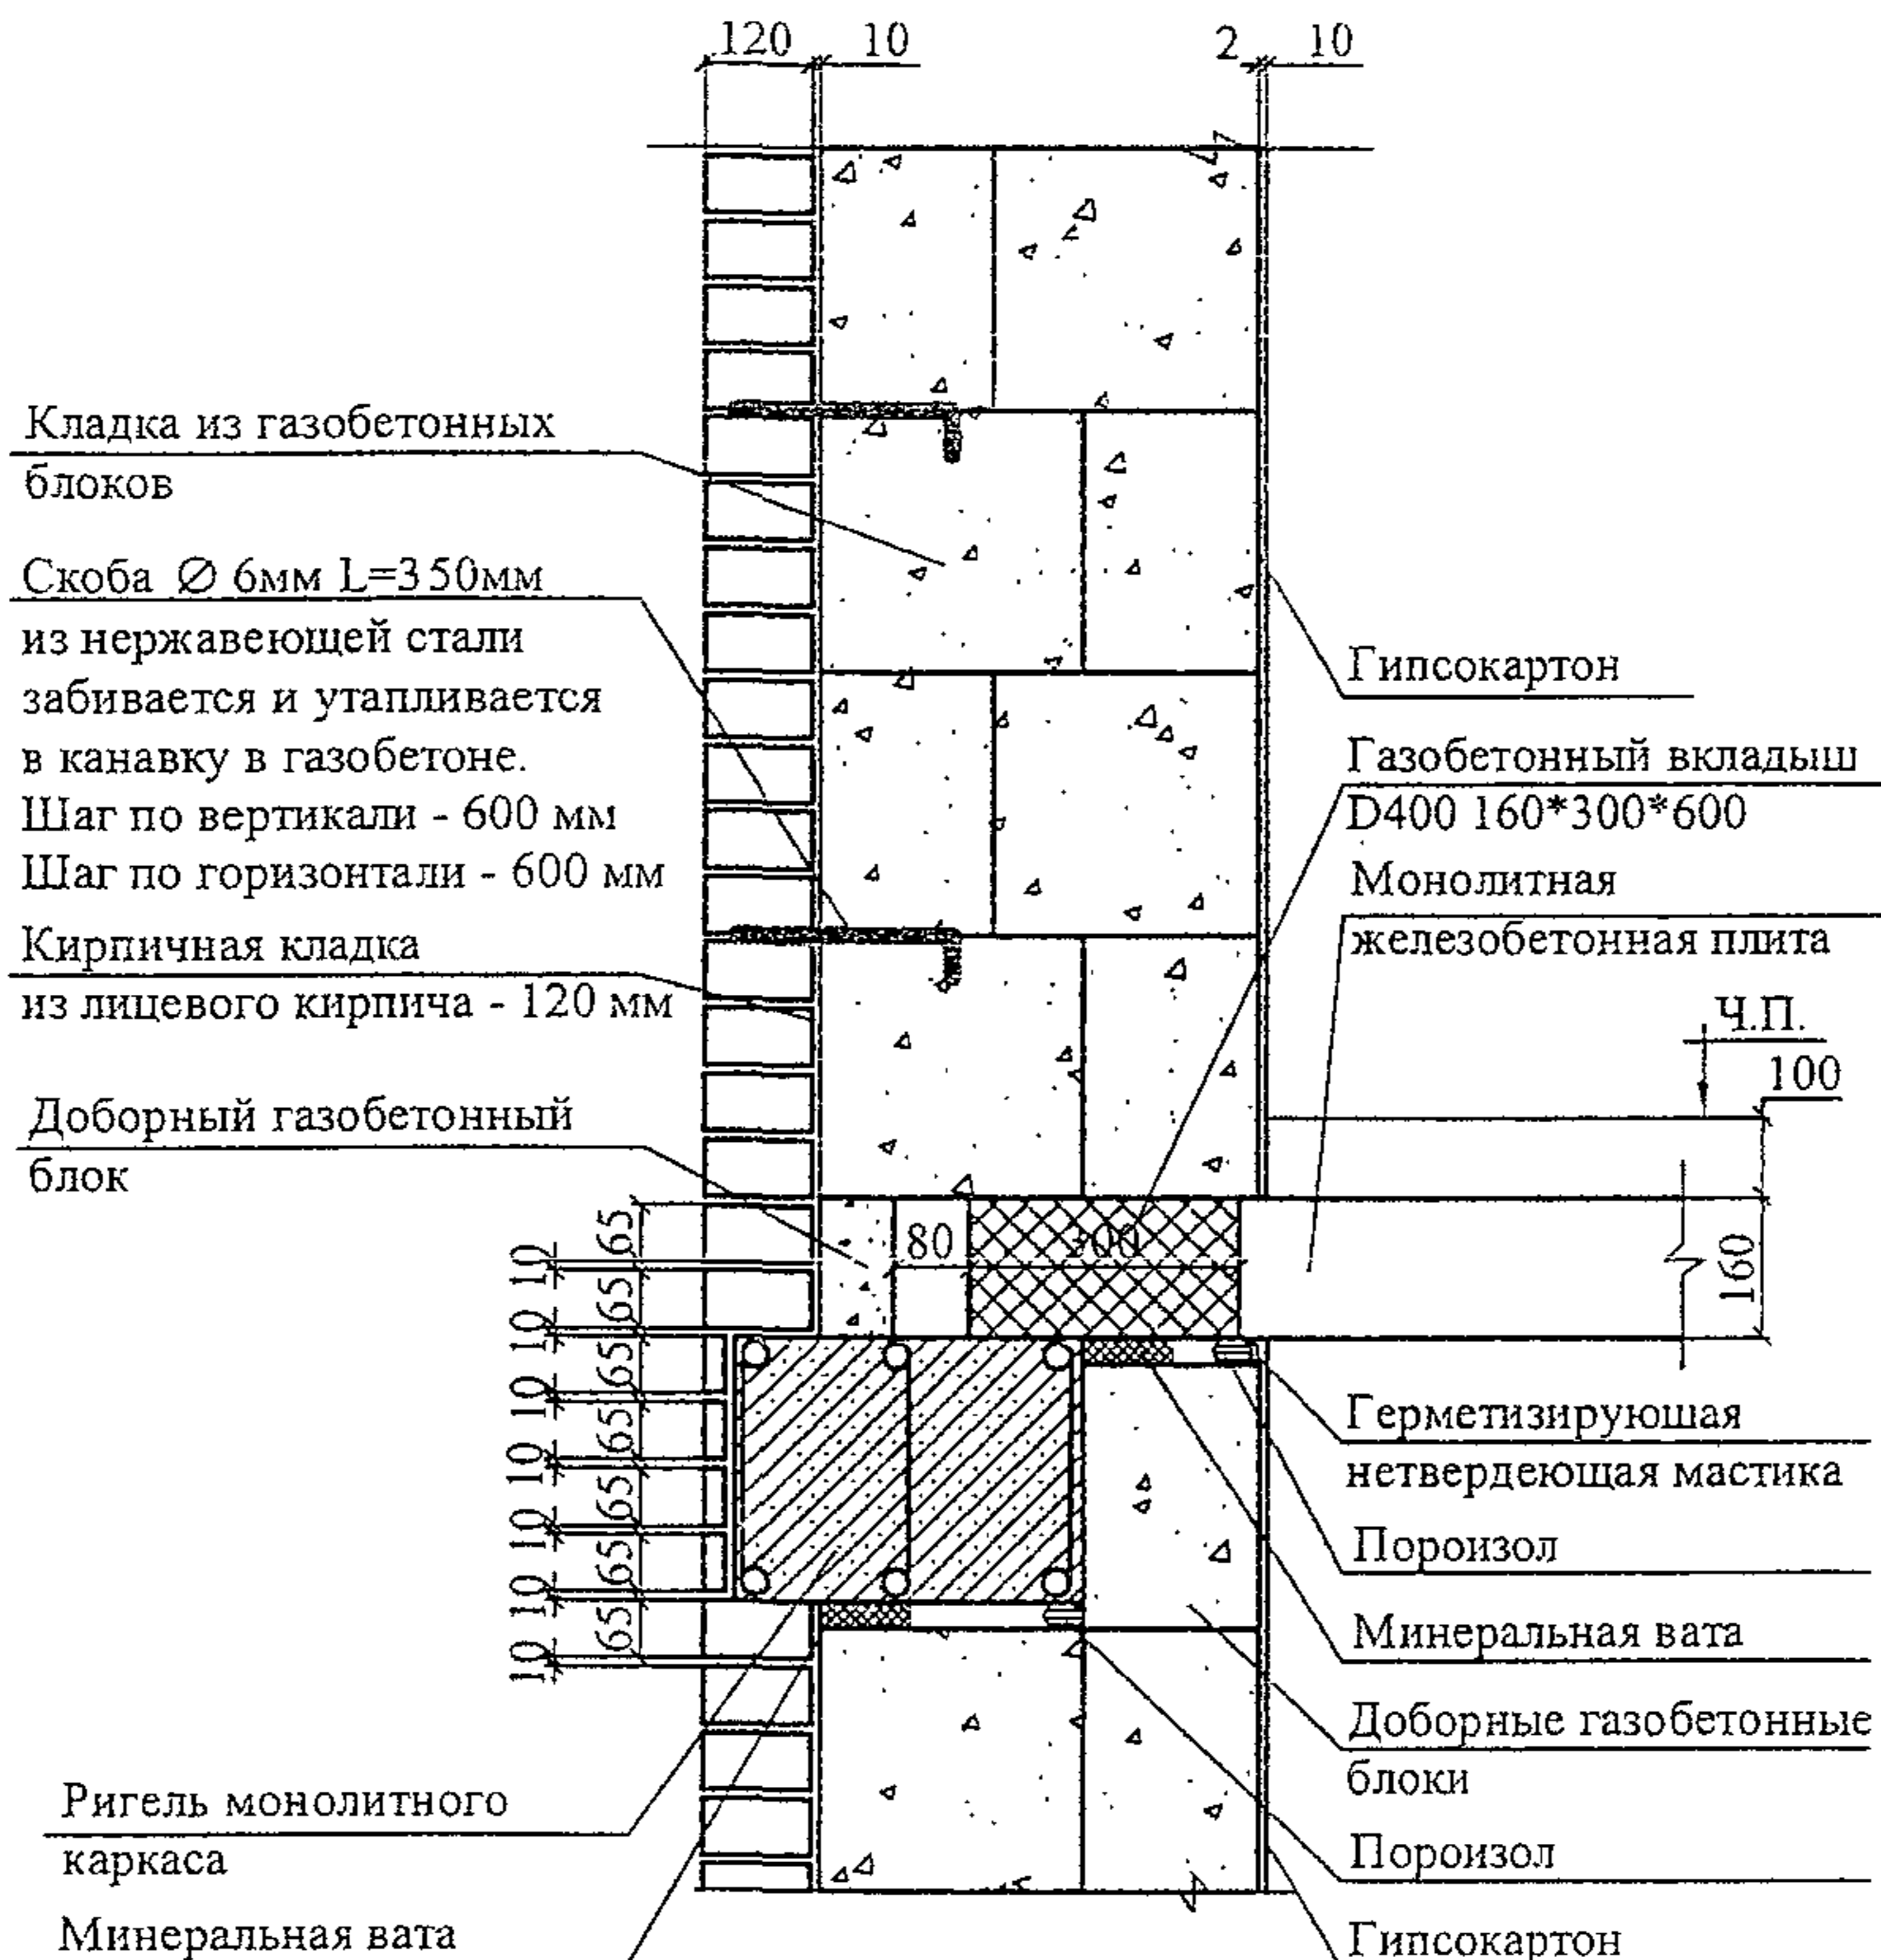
Стена с опиранием газобетонных блоков и кирпичной облицовки на ригели встроенного каркаса
